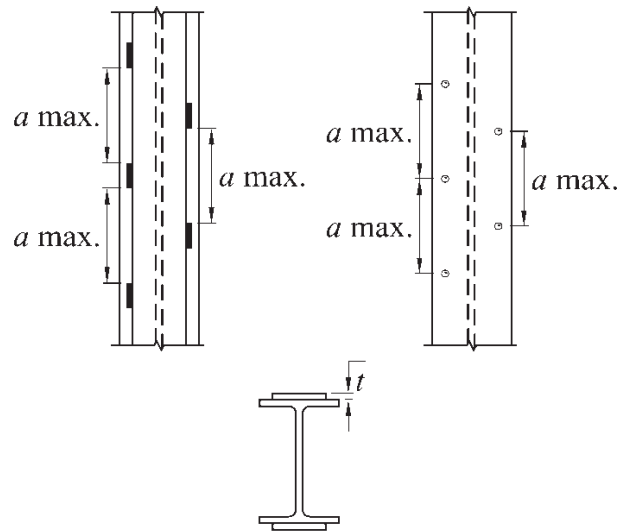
Miembros armados. Separación máxima “a” de elementos de unión
